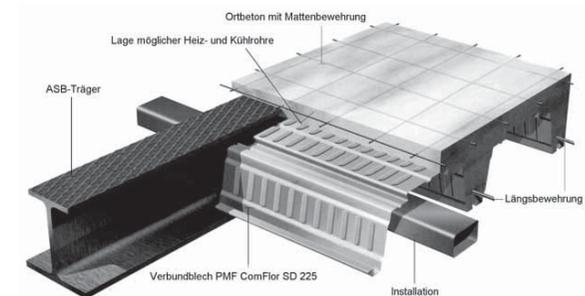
Stahlflachdecke mit tiefsickentrapezprofilen „Slimdek“
